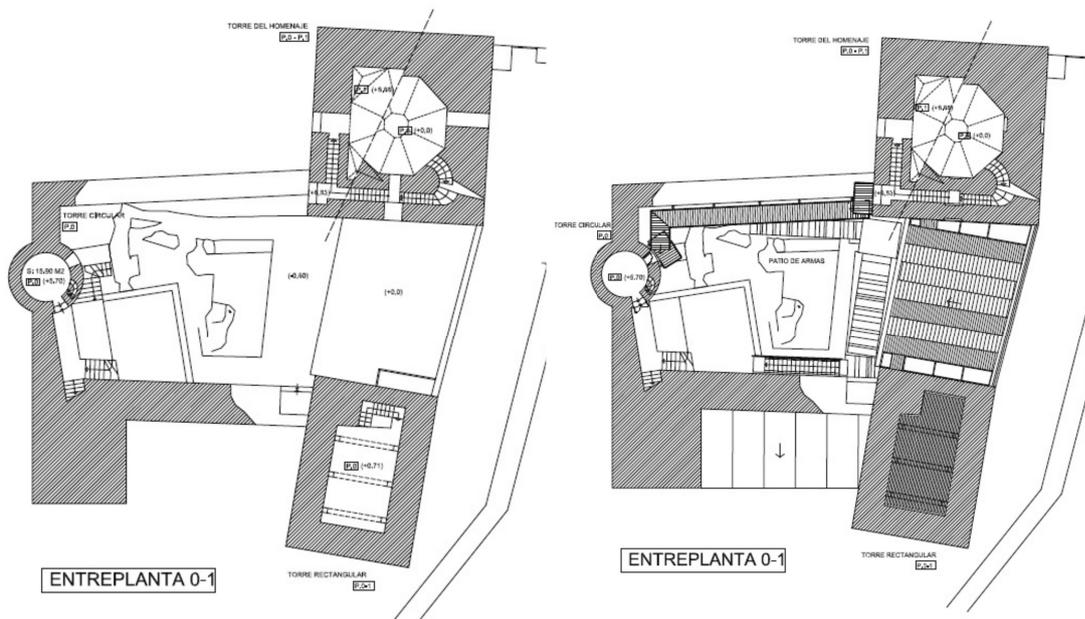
Proyecto. Planta general del alcázar. Estado actual y reformado
